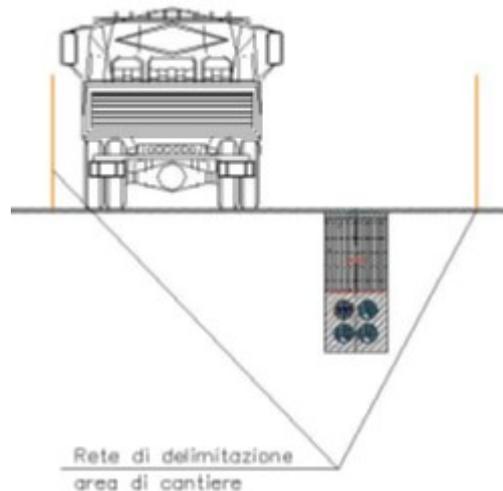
Sezione dell'area di cantiere dell'elettrodotto in cavo interrato
